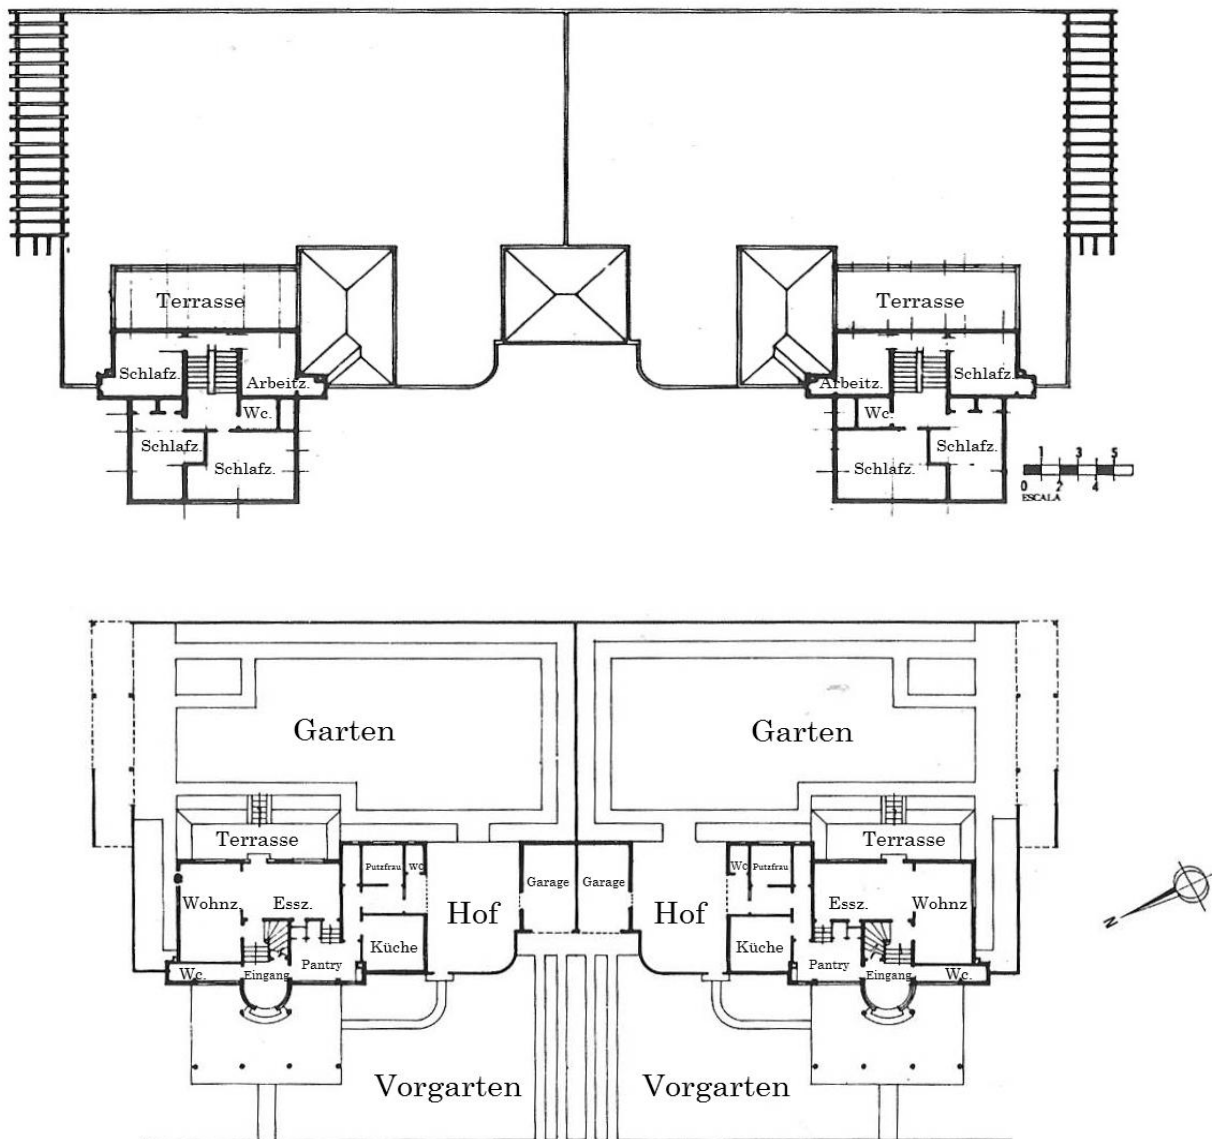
Grundrisse des Erd- und Obergeschosses der Meisterhäuser.
